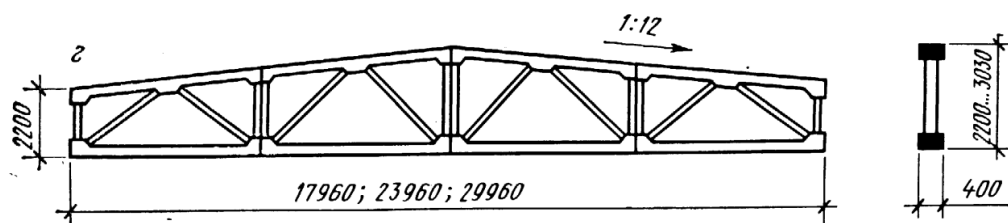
Составная двухскатная железобетонная ферма, состоящая из двух полуферм с предварительно–напряженным нижним поясом
